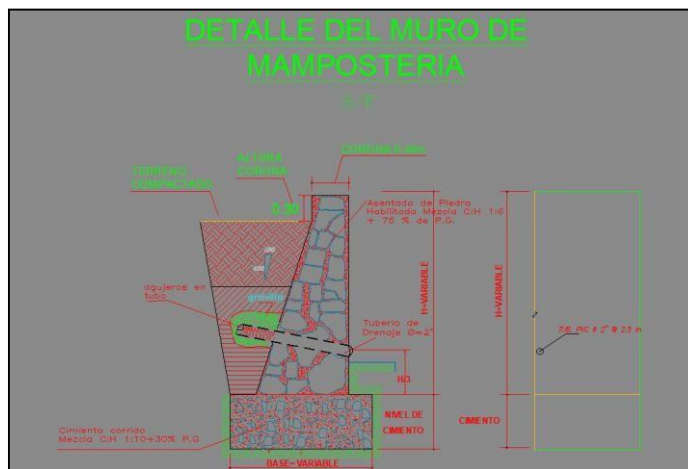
Detalle de muro de Mampostería, especificando todos los componentes del muro.
